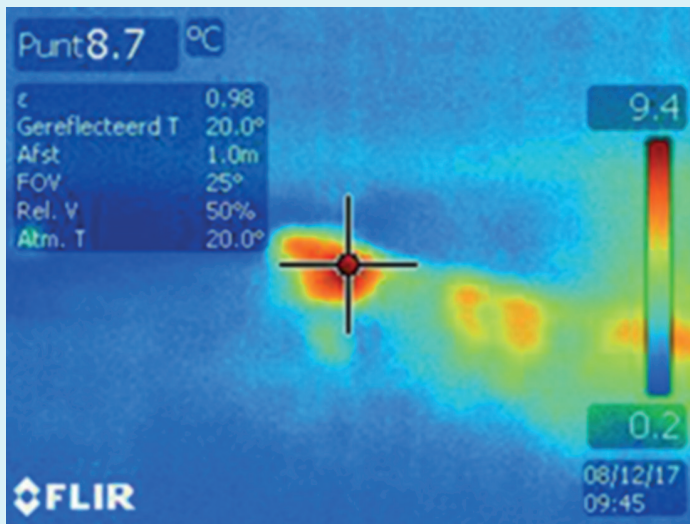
Het kruisje bevindt zich op de aansluiting lood, gevel en kozijn.
